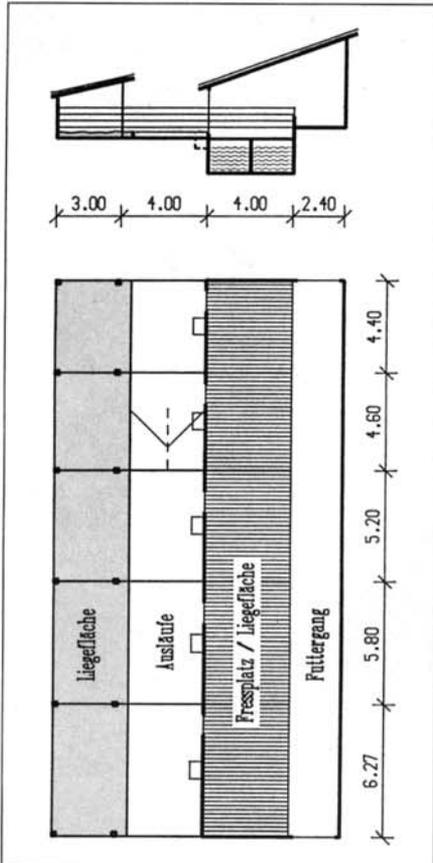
Grundriss und Querschnitt der Lösung Gutsbetrieb Hoheneegg.
